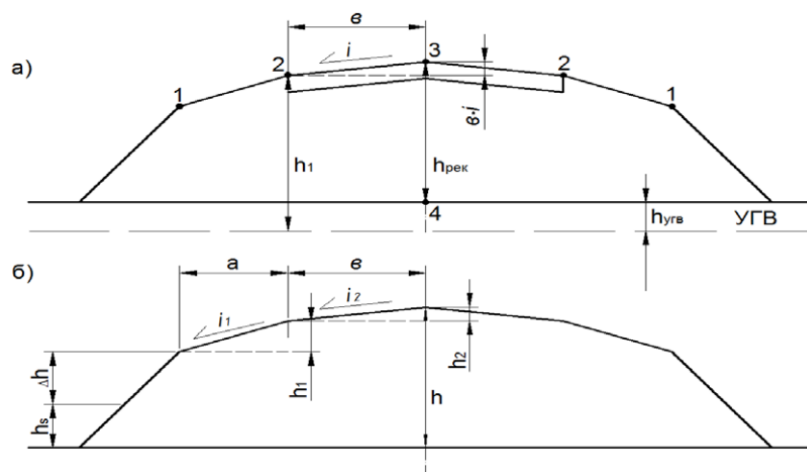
Схема определения руководящей рабочей отметки [20, 34]:
